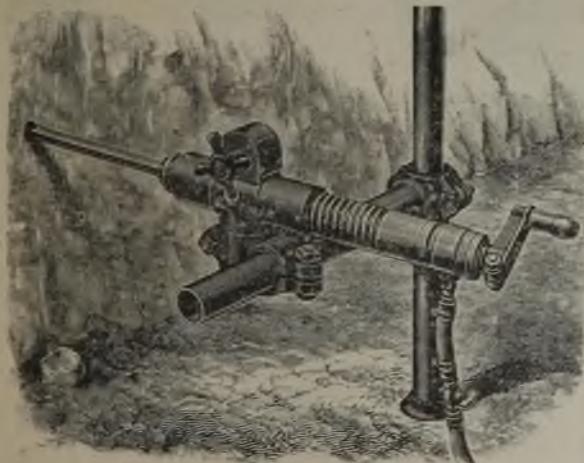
Verlagerung der Schlagbohrmaschine mit Halter. Hardsogg Wonder Drill Co., Ottumwa, Iowa.
